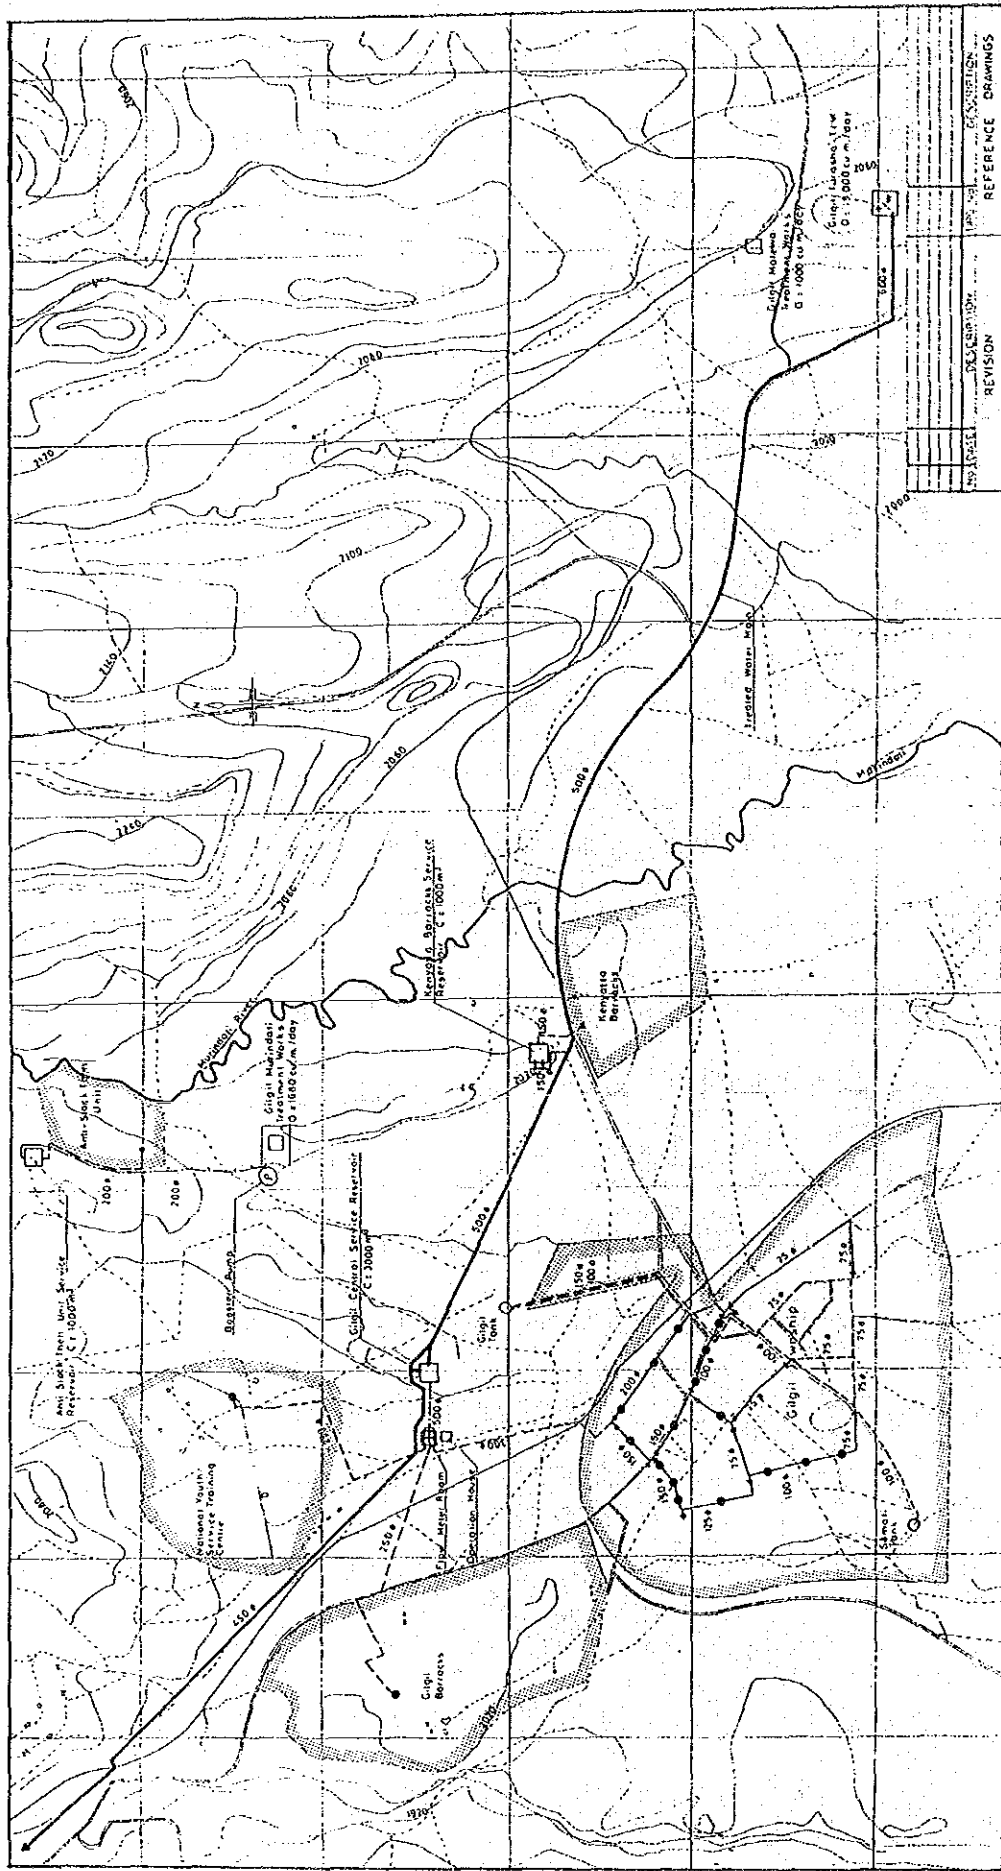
大ナクル水供給計画施設平面図(施設、送水管等)
